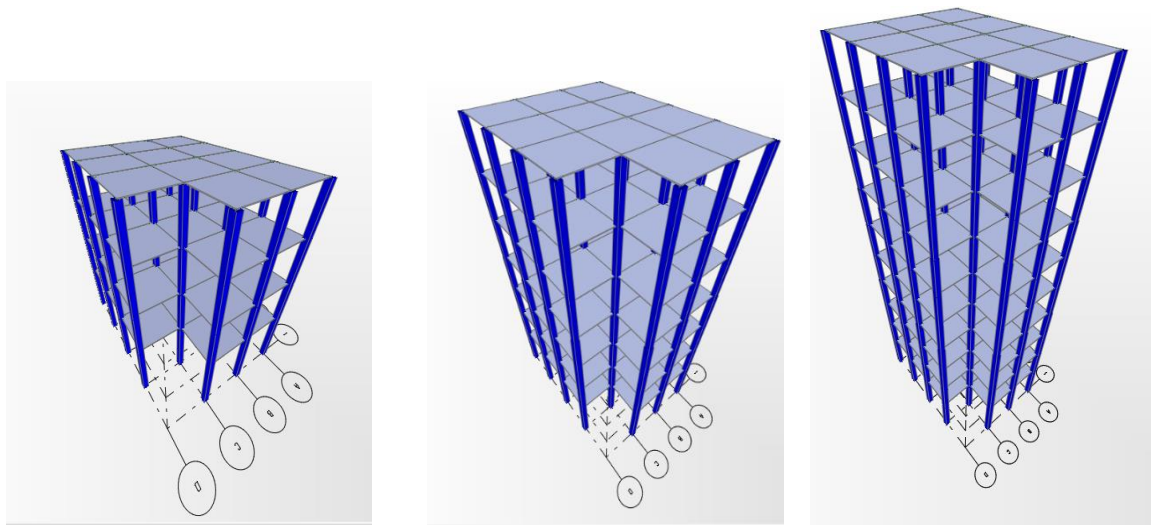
Portiques faiblement irréguliers en plan R+3, R+6, R+9.
